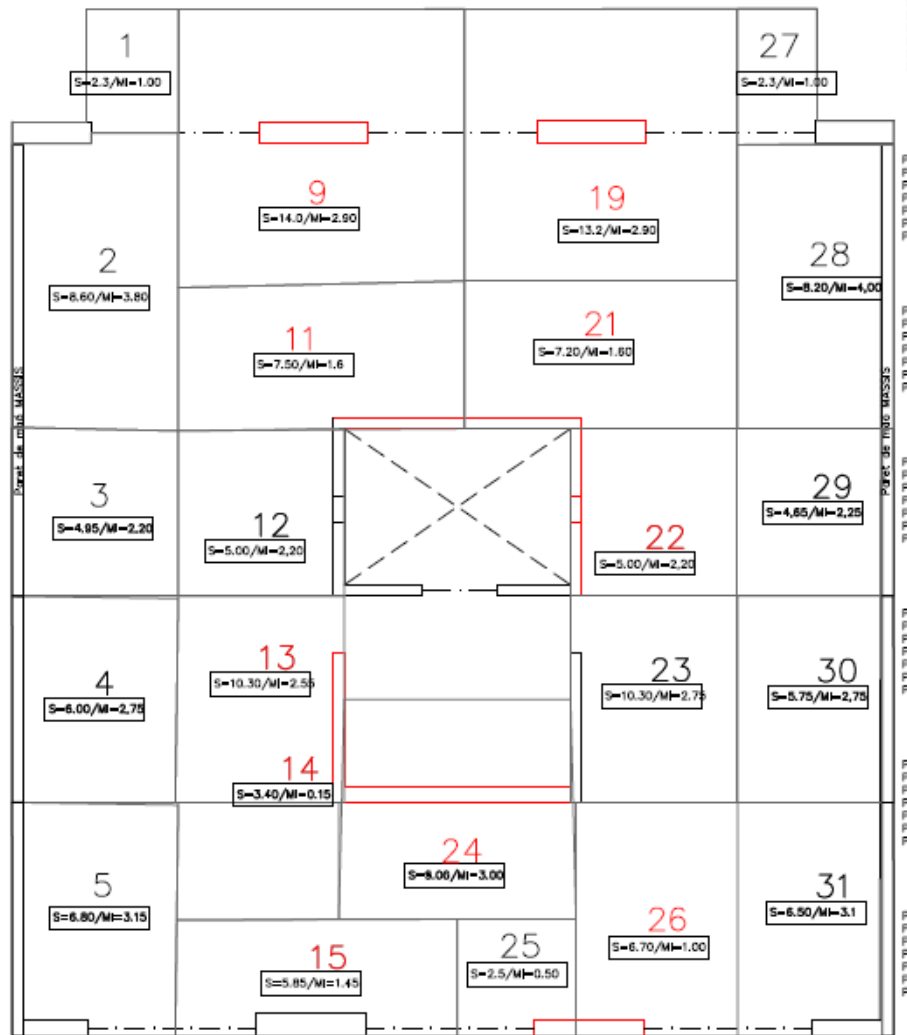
Planta Baixada de càrregues (en vermell les que excedeixen el coef seg)
